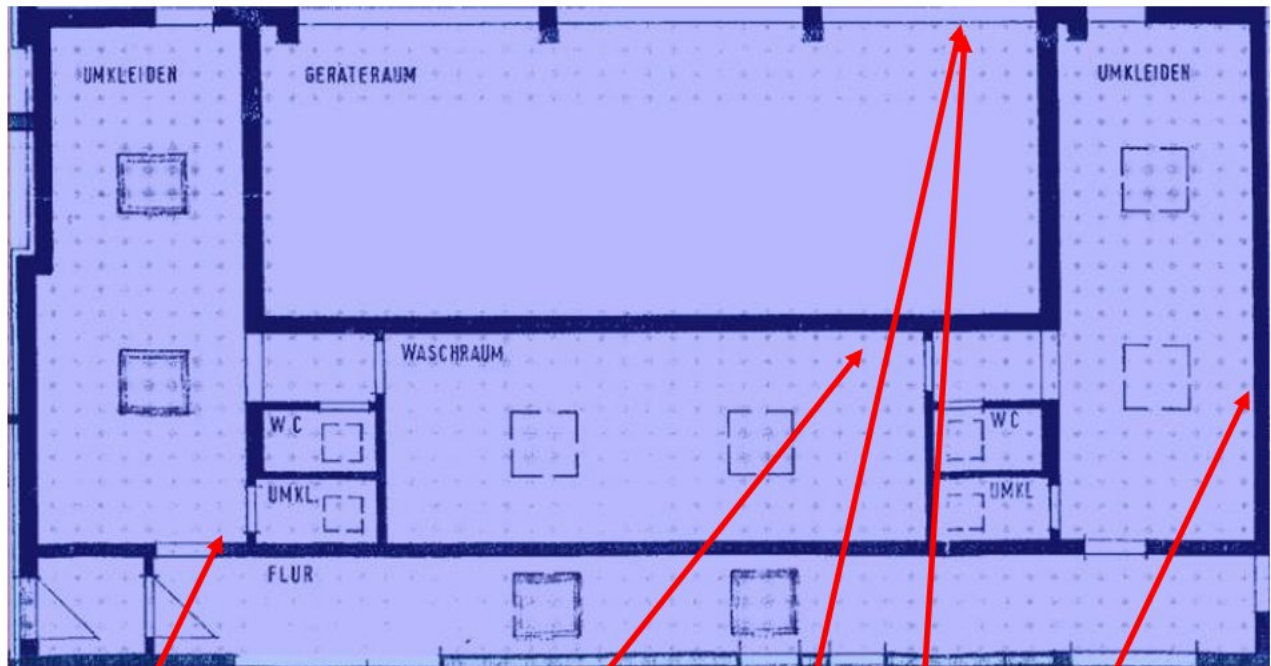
Teilbereich (siehe Grundriss)
